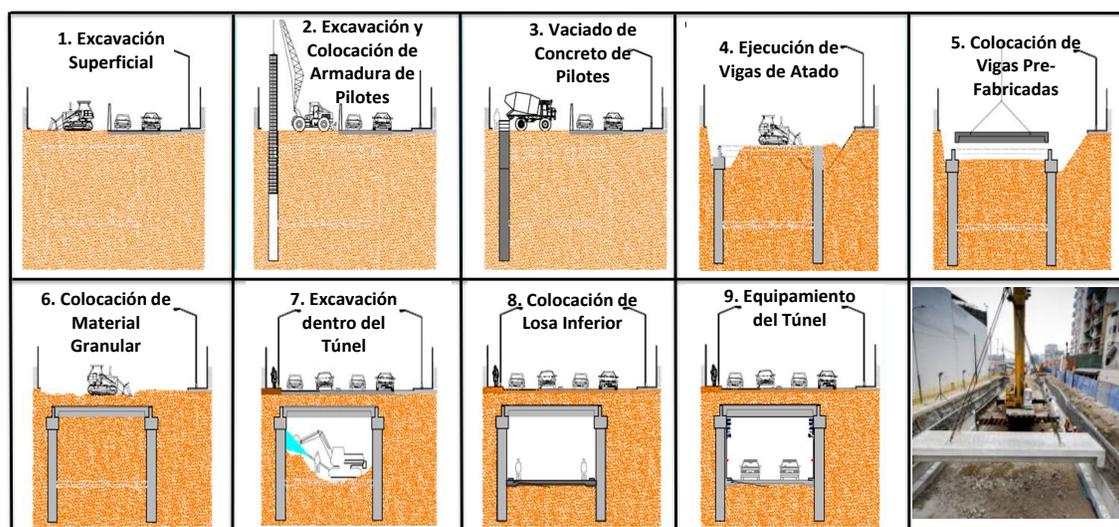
Secuencia Constructiva para la Ejecución del Túnel
